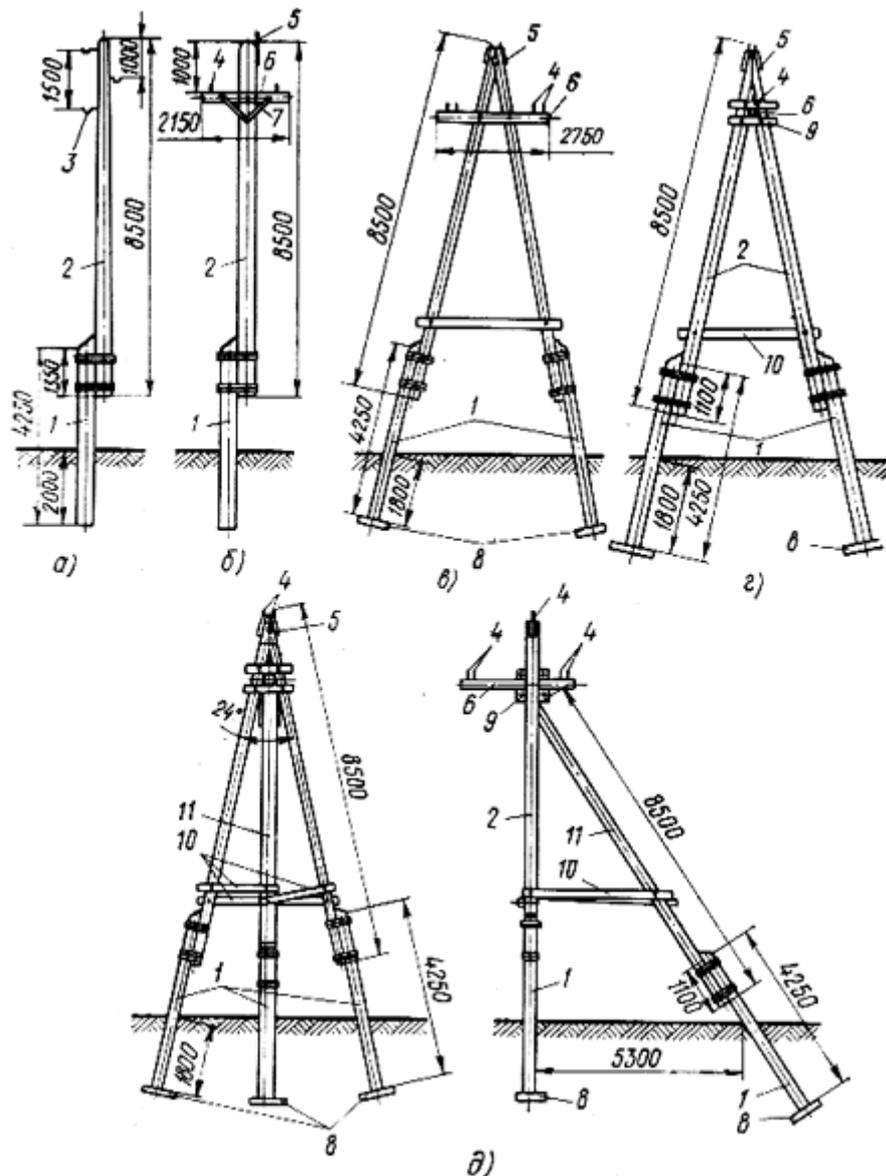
Деревянные опоры ВЛ 6-10 кВ:
